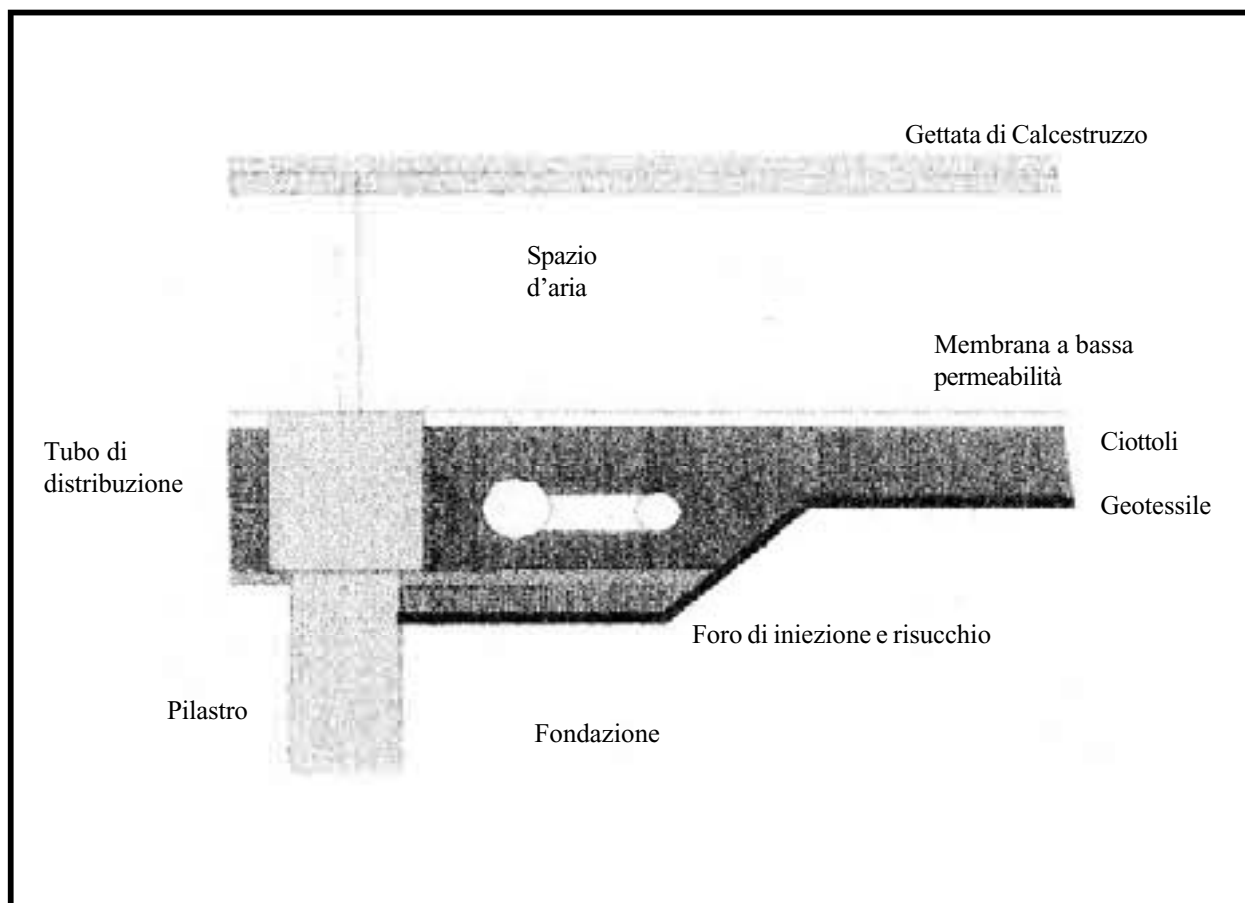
Sezione del piano di costruzione e sistema di ventilazione del gas
